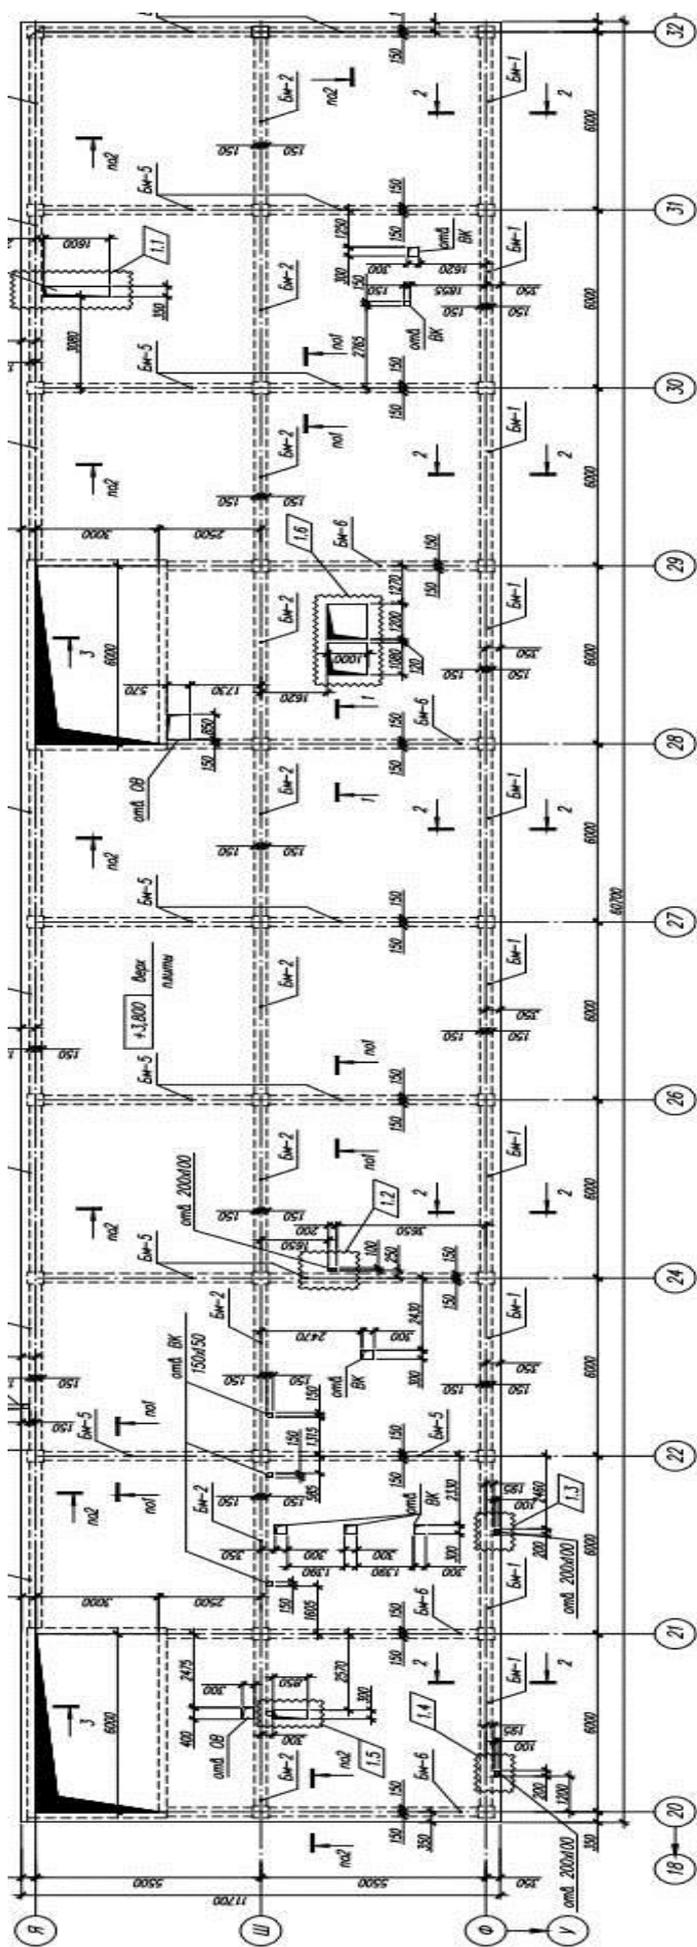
План монолитного ребристого перекрытия с балочными плитами
